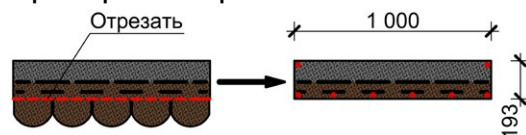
Схема изготовления карнизной черепицы из рядовой и расположение гвоздей.
